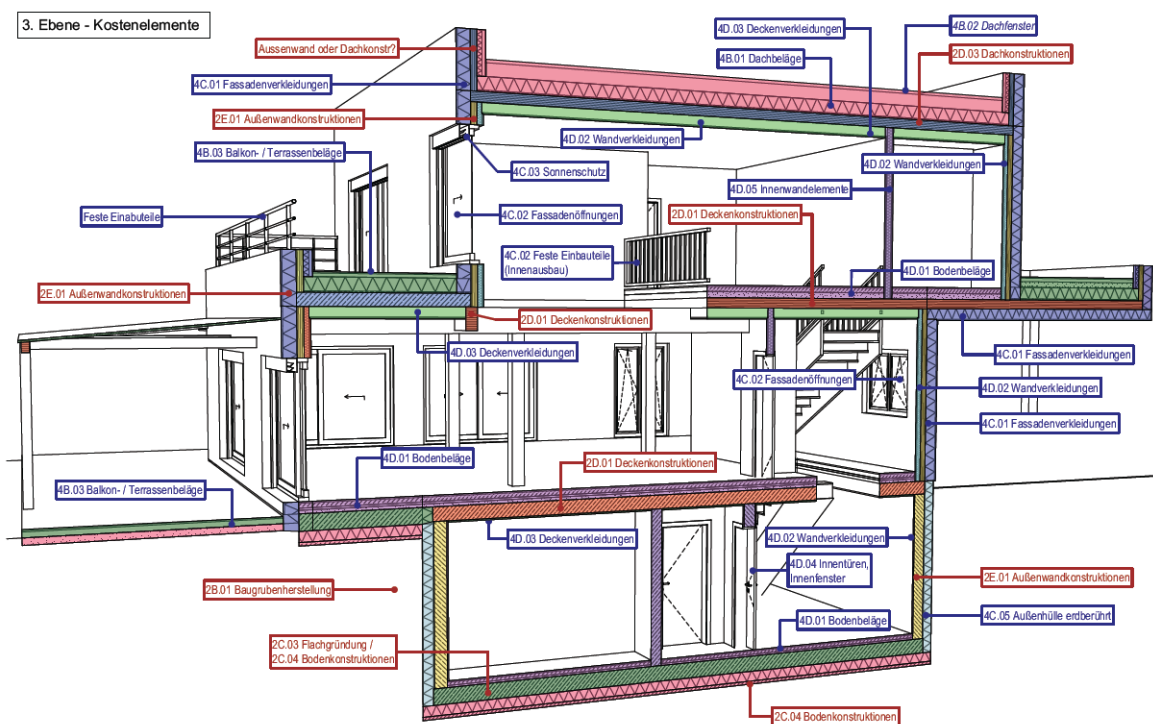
Testgebäude Elemente 3. Ebene (ÖNORM B 1801-1:2009)
